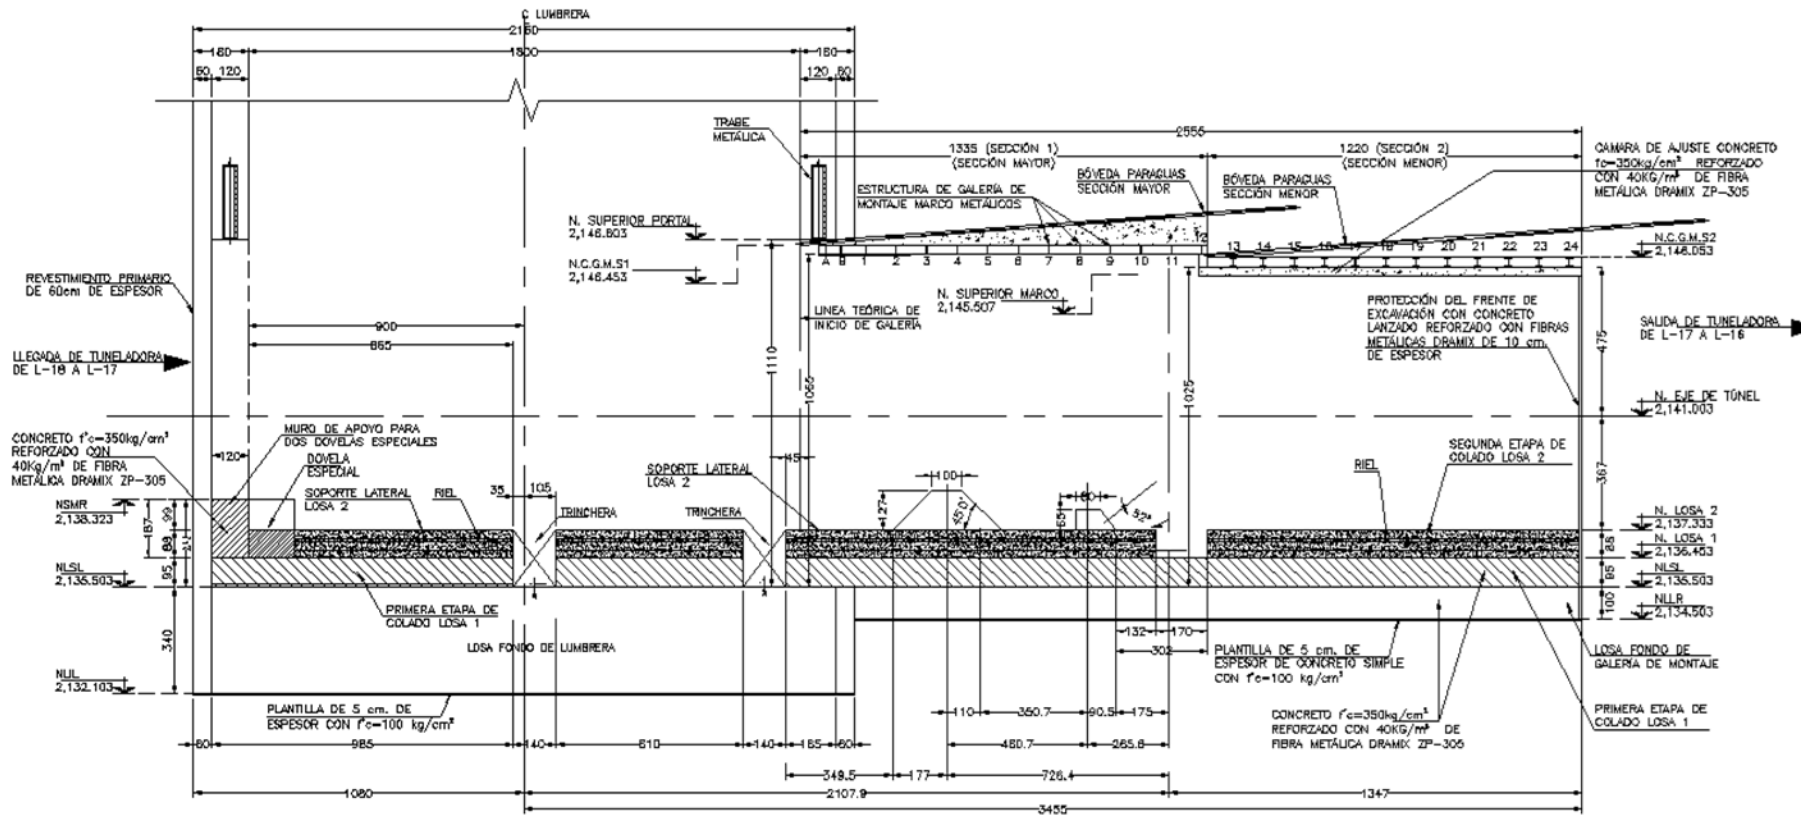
Vista de perfil de adecuaciones en galería y fondo de lumbra.
